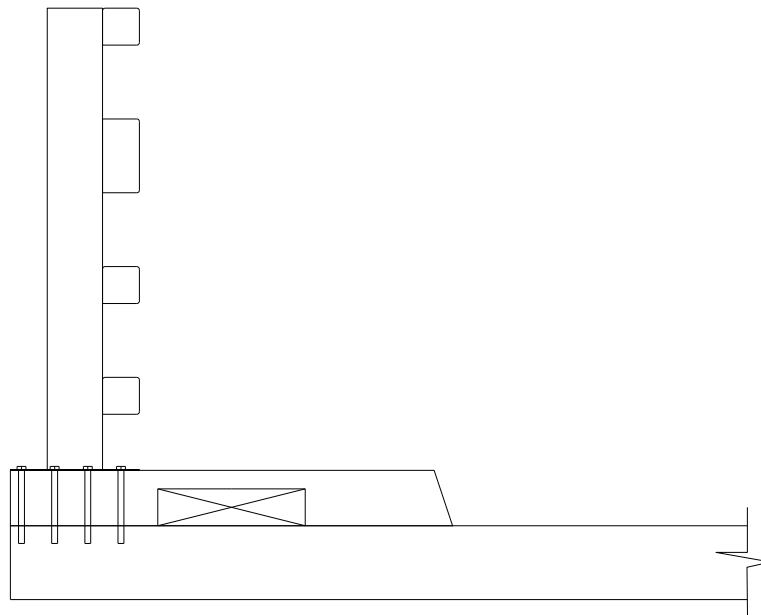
Vista transversal de baranda y anclajes. Elaborado por: Autores.
